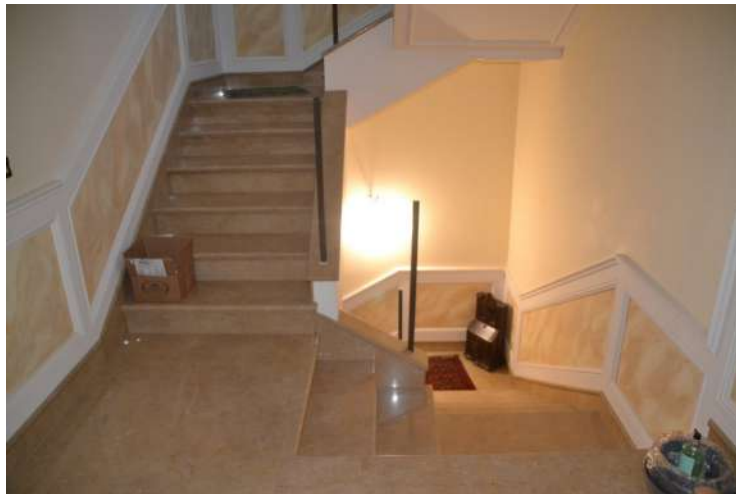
SCALA DI ACCESSO PIANO PRIMO
